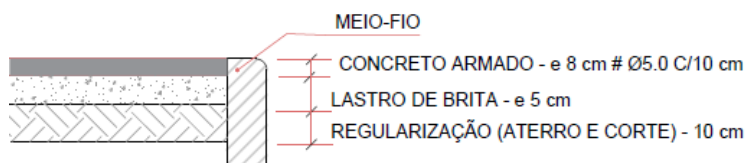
Corte Transversal – Execução de Concreto 8 cm Armado
